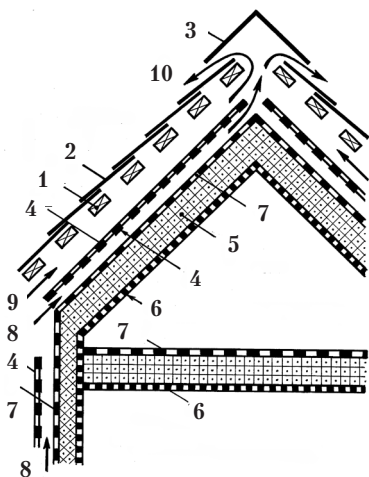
Схема монтажа специализированных гидроизоляционных плёнок марок «Изоспан». 1 – обрешетка крыши, 2 – кровля (металлочерепица), 3 – конёк, 4 – антиконденсатная плёнка Изоспан -А, 5 – теплоизоляционная плита из минваты, 6 – пароизоляционная плёнка Изоспан-В, 7 – гидроветрозащитная паропроницаемая плёнка Изоспан-AS, 8 и 9 – потоки воздуха через вентиляционные зазоры, 10 – вывод увлажненного (от сушки подкровельного пространства) воздуха через зазор под коньком крыши.
